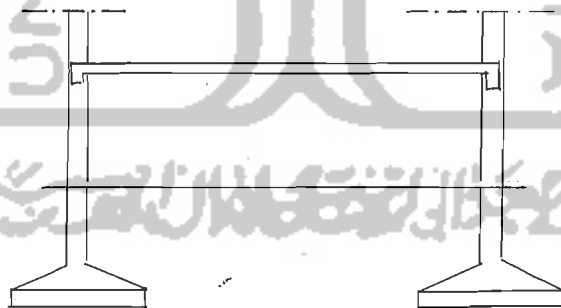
Sistem Fondasi yang Direkomendasikan
